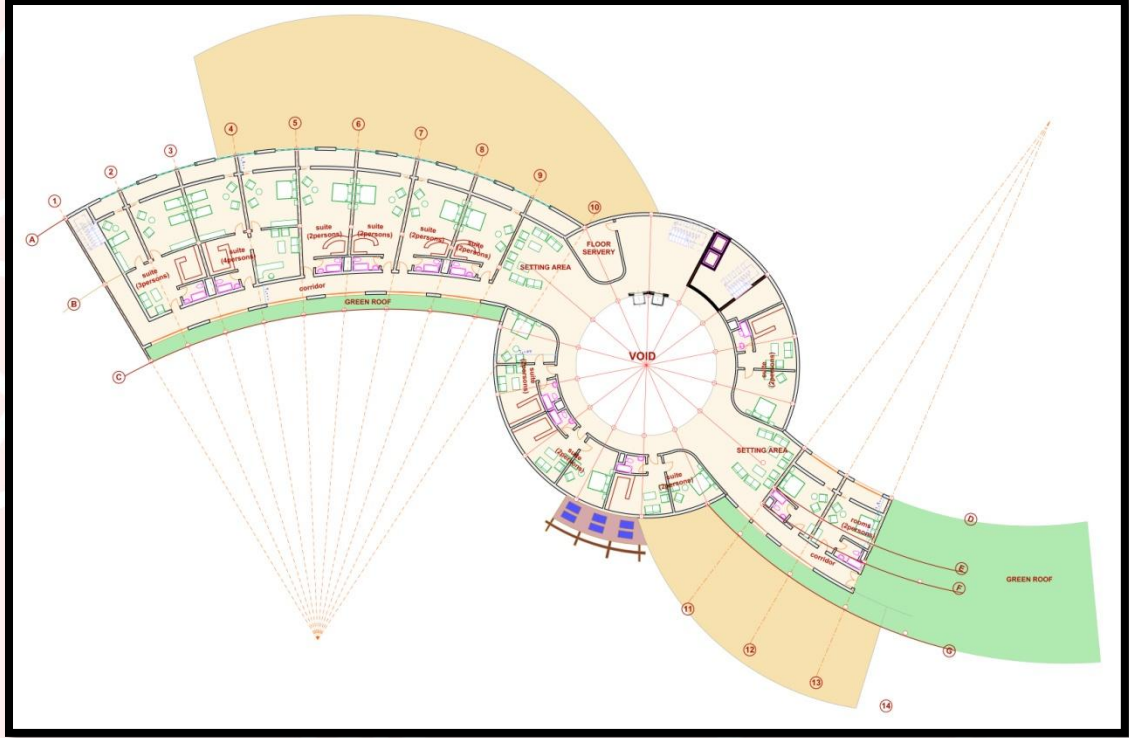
7<sup>th</sup> Floor Plan in development stage
